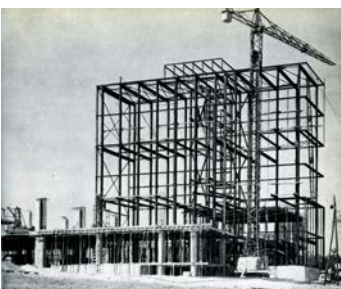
Imagen de la estructura en construcción con las cruces de arriostramiento de la estructura. Fuente: Informes de la Construcción.
